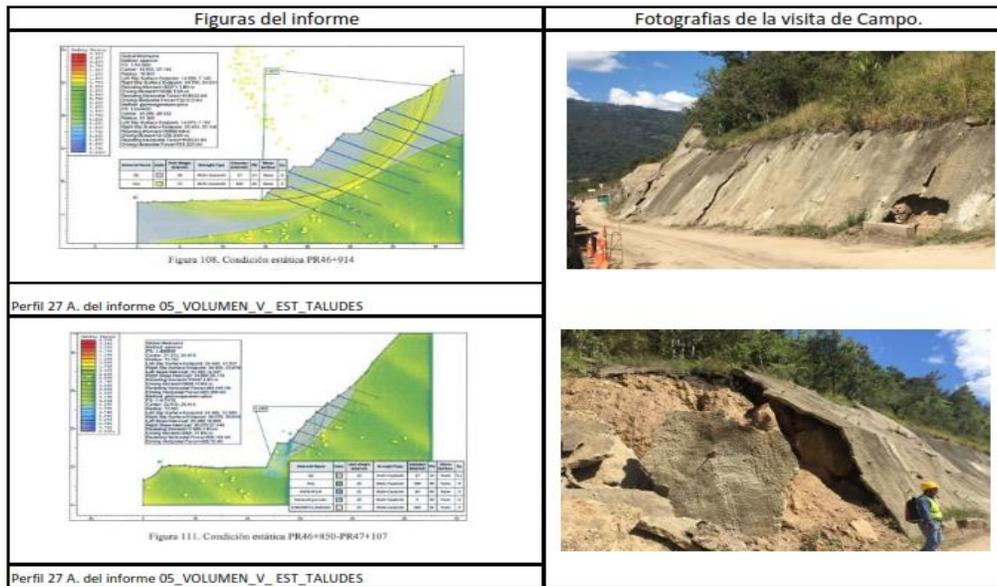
Comparación entre las secciones analizadas y las secciones construidas.
